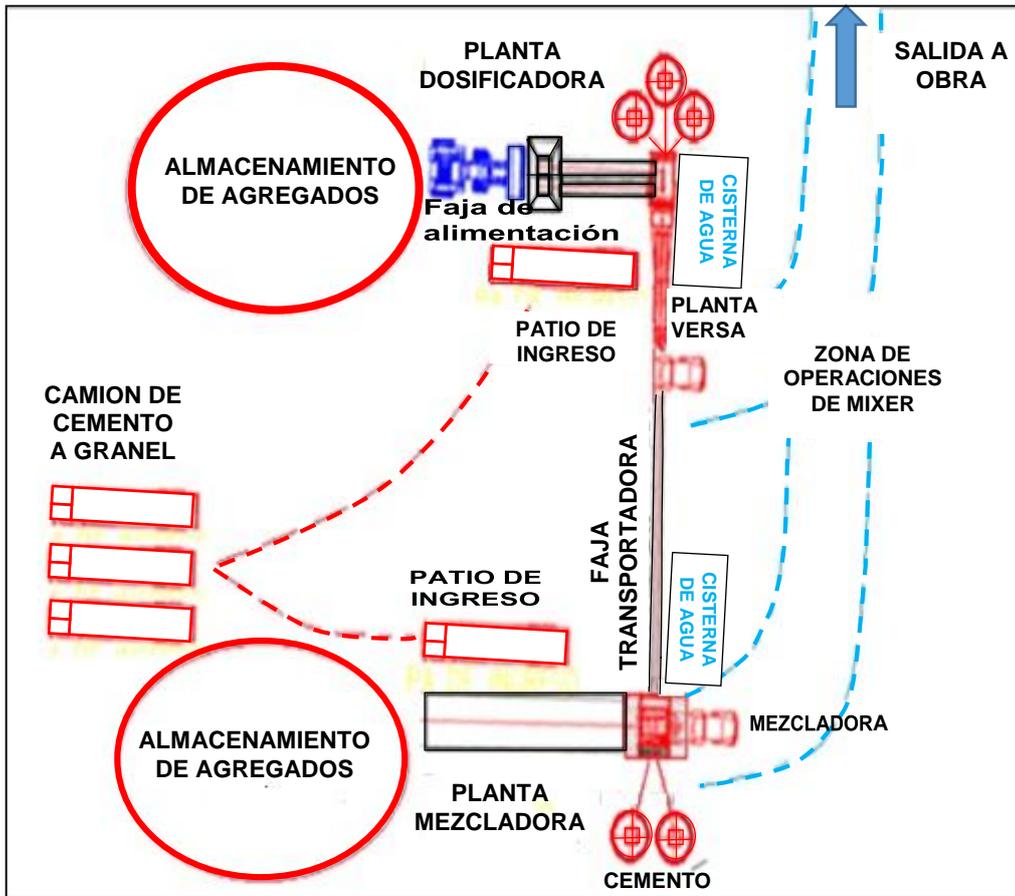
Ubicación y dimensionamiento de la Planta de Concreto Premezclado, tramo II de la construcción del viaducto del tren eléctrico
